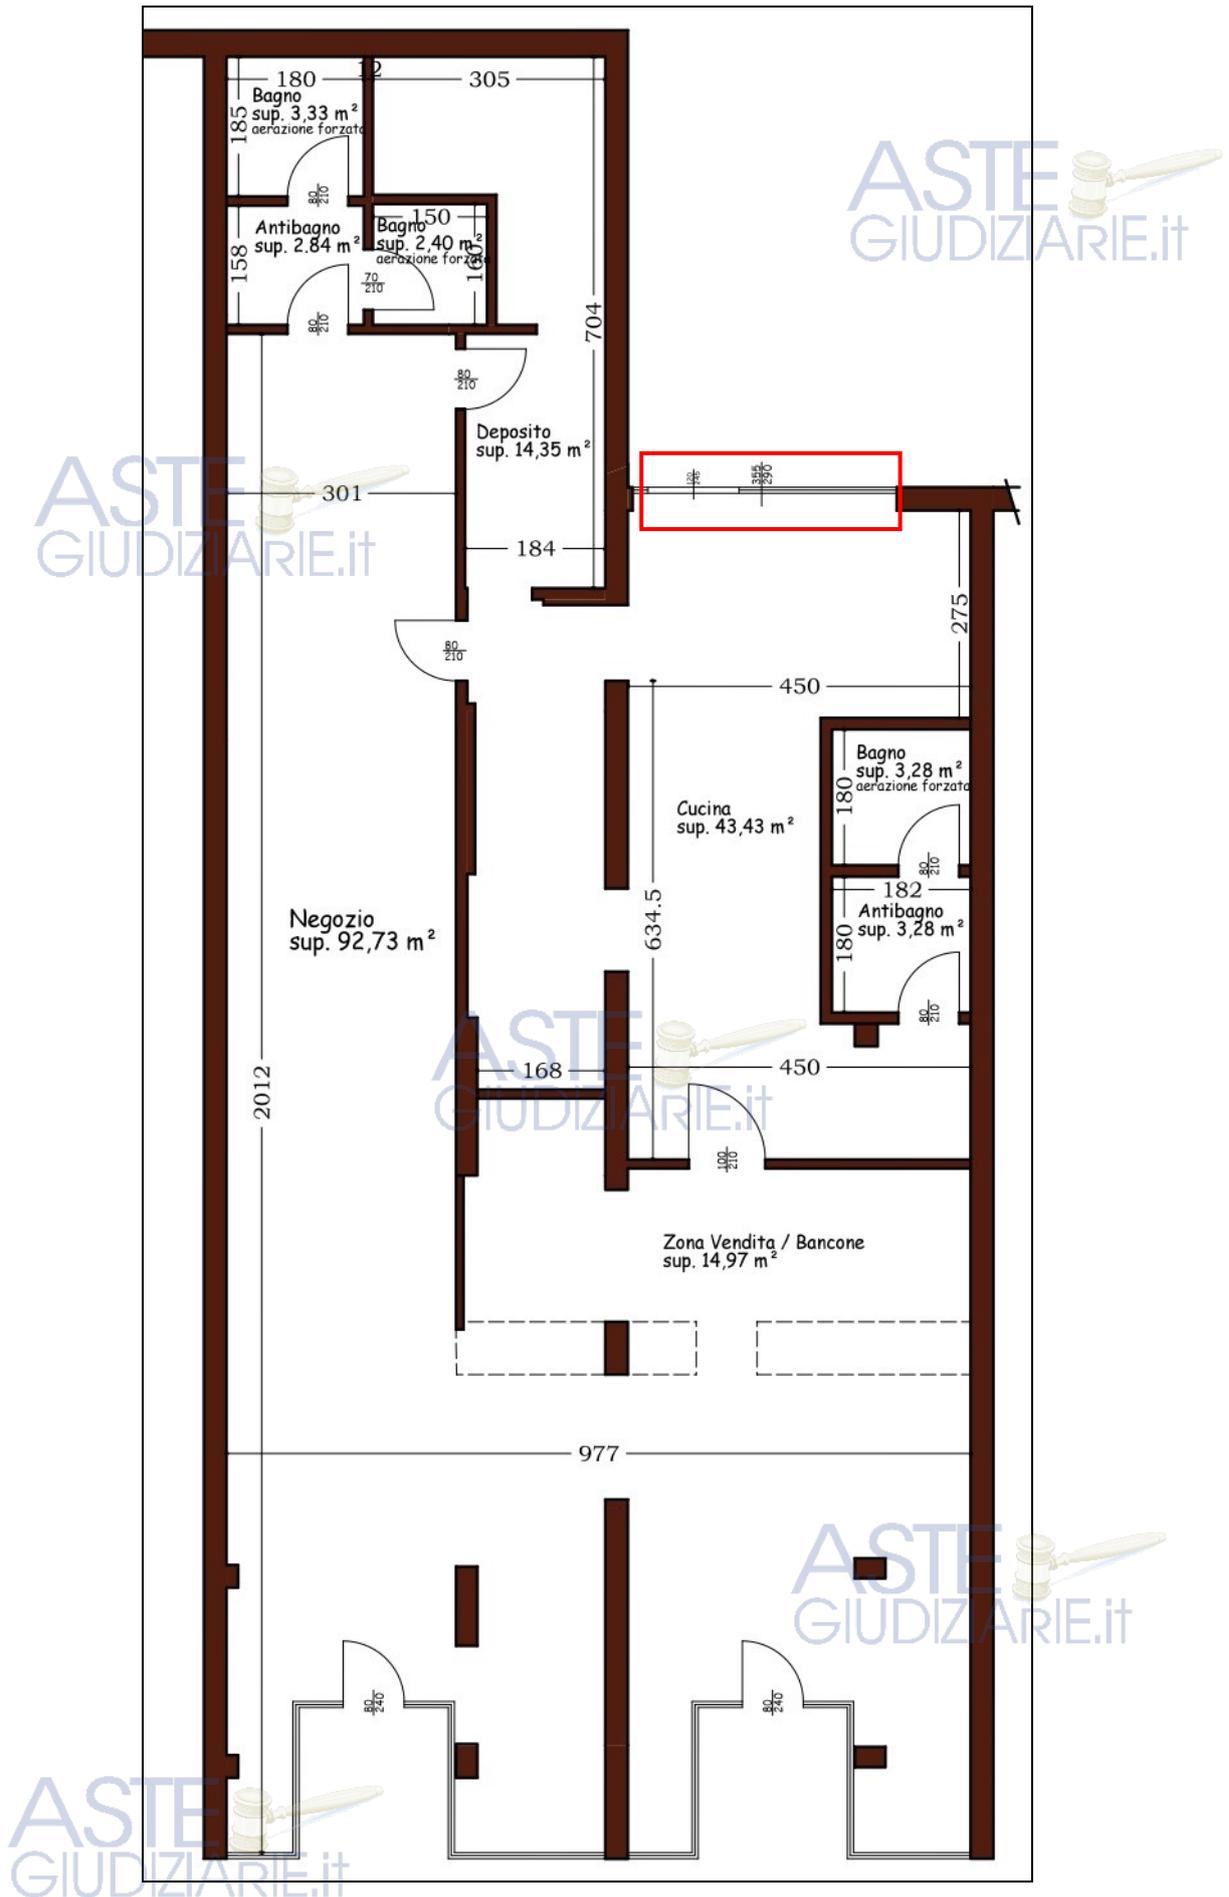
Estratto pianta di progetto con indicazione difformità rilevate
